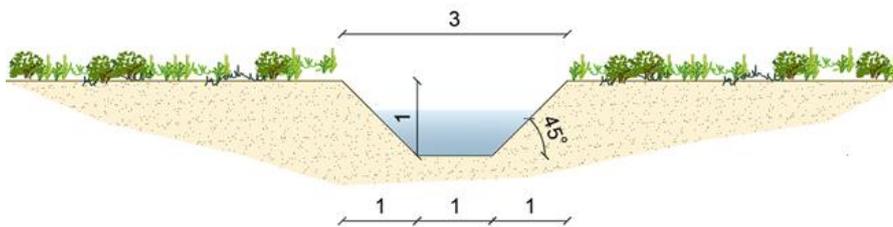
Sezione trasversale del canale in progetto "Tipo 2"
